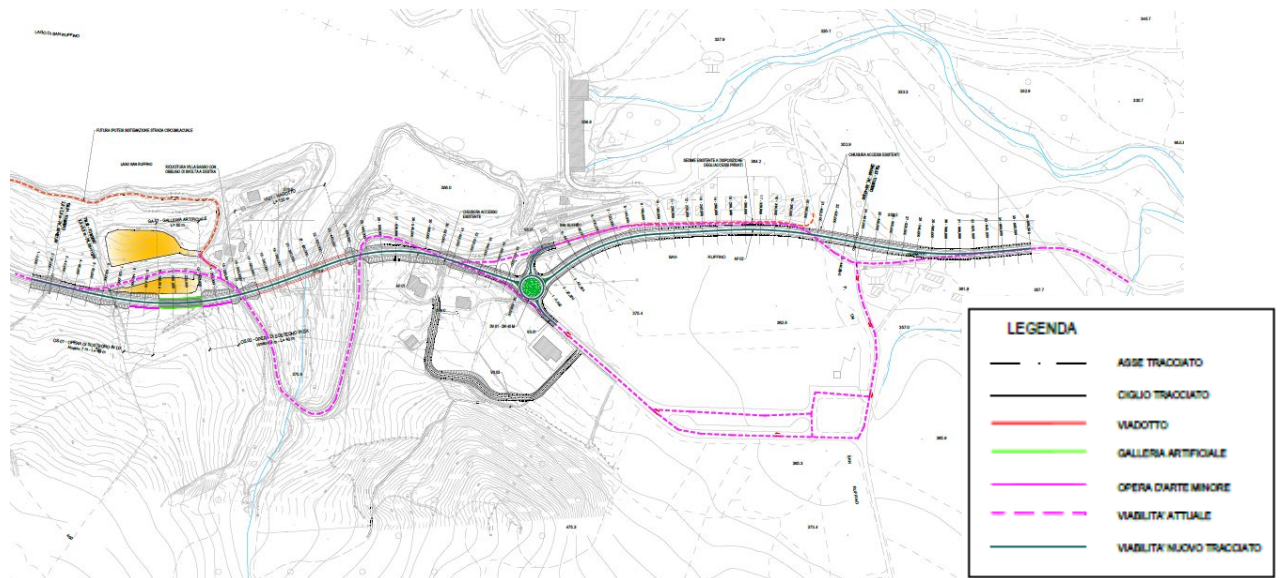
Planimetria area di cantiere e viabilità di servizio
